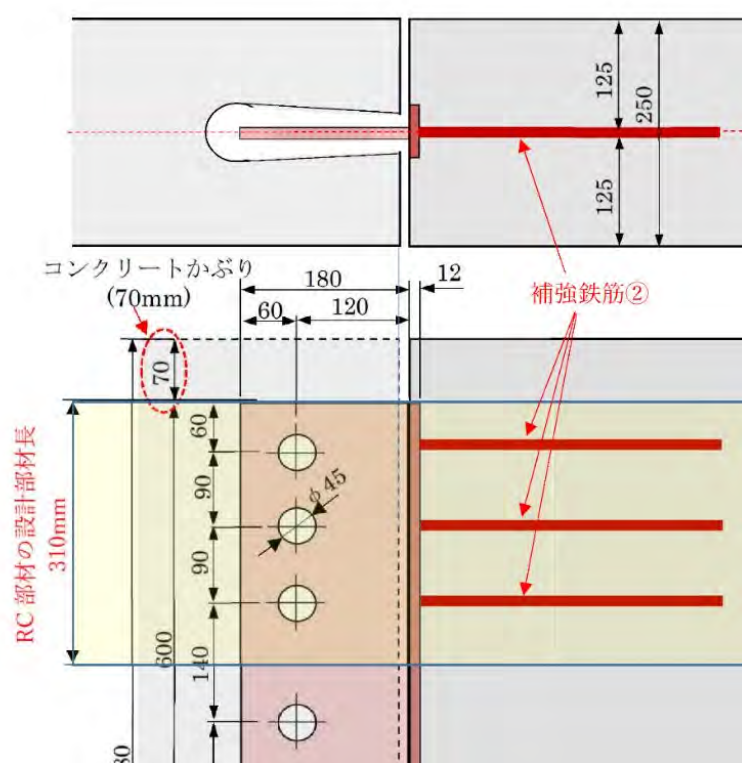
補強鉄筋②の設計範囲と補強鉄筋の配置
